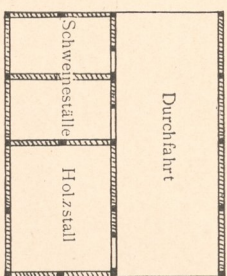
Spieker in Lehre. Grundriss.
